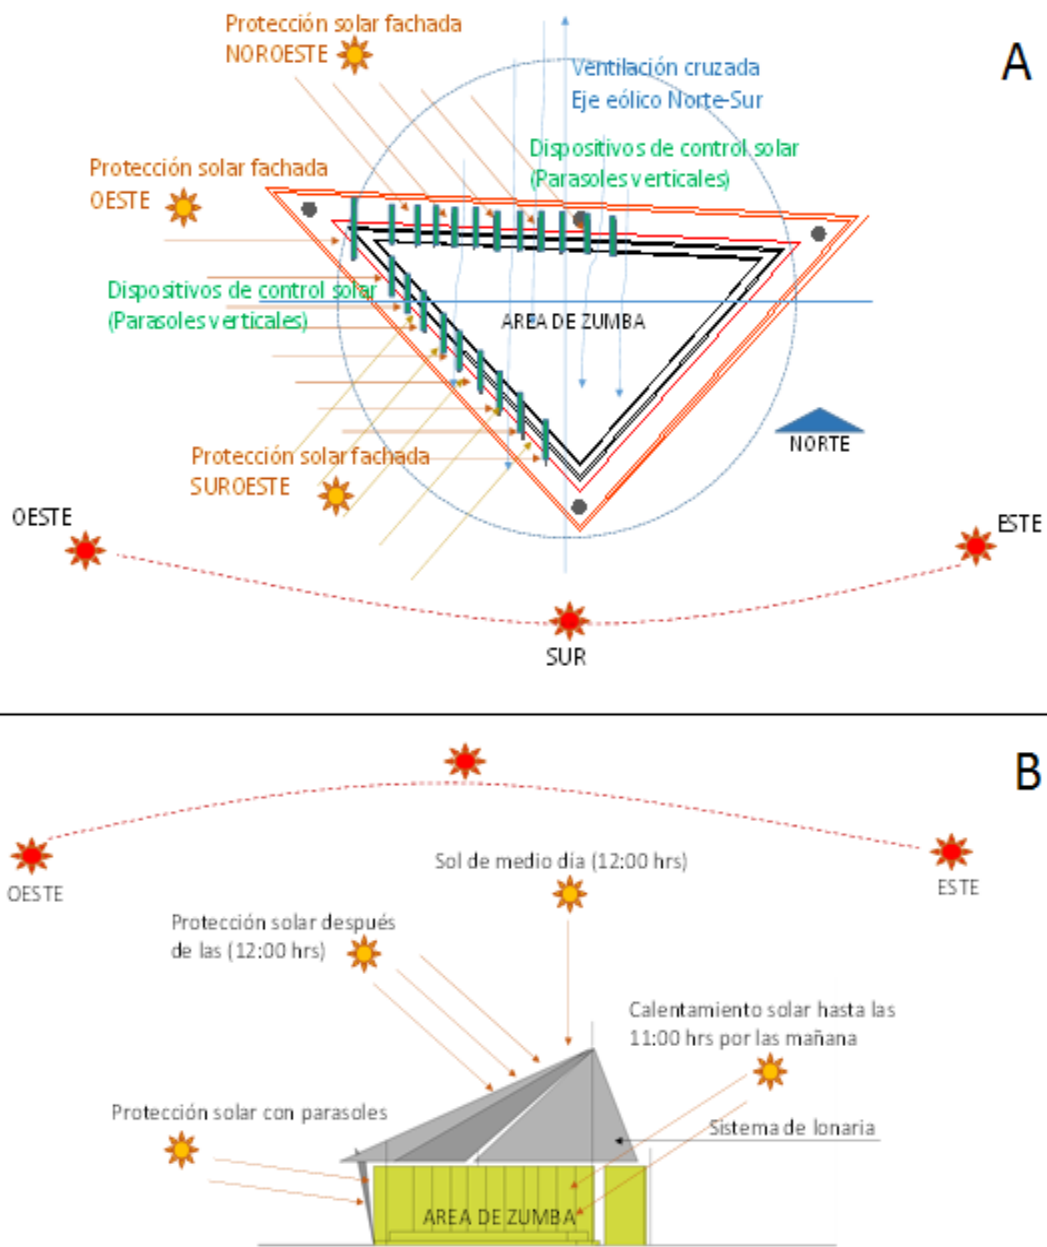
A) Planta arquitectónica del área de zumba, B) Sección transversal área de zumba.
